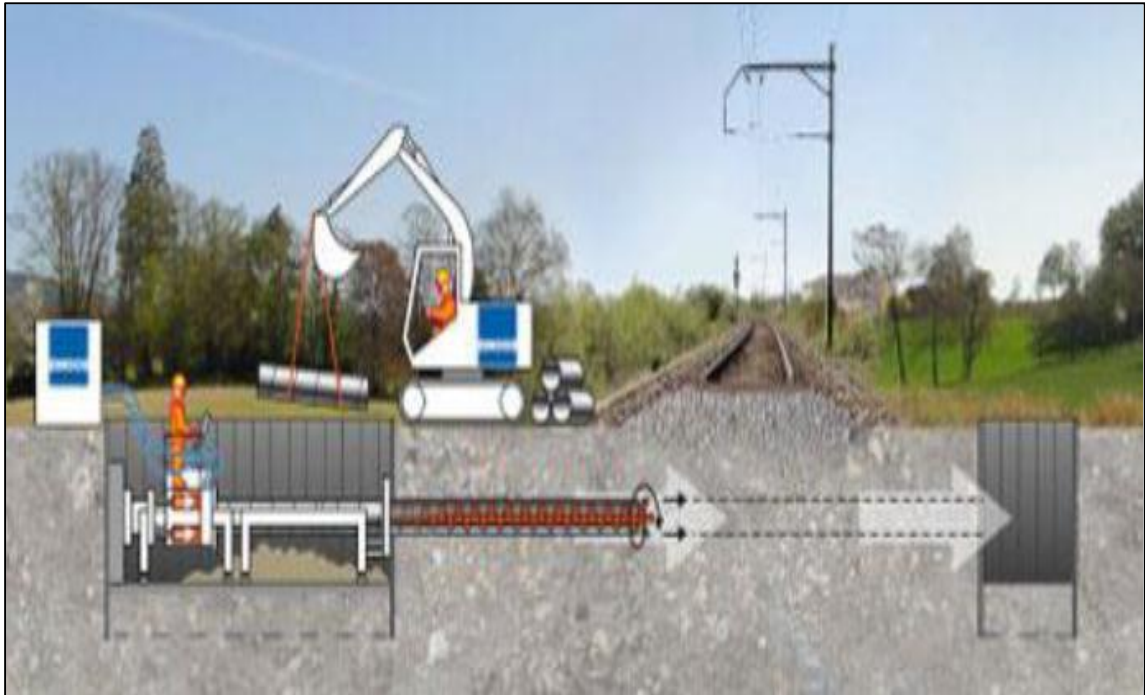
Pose à proximité d'une conduite d'assainissement.
